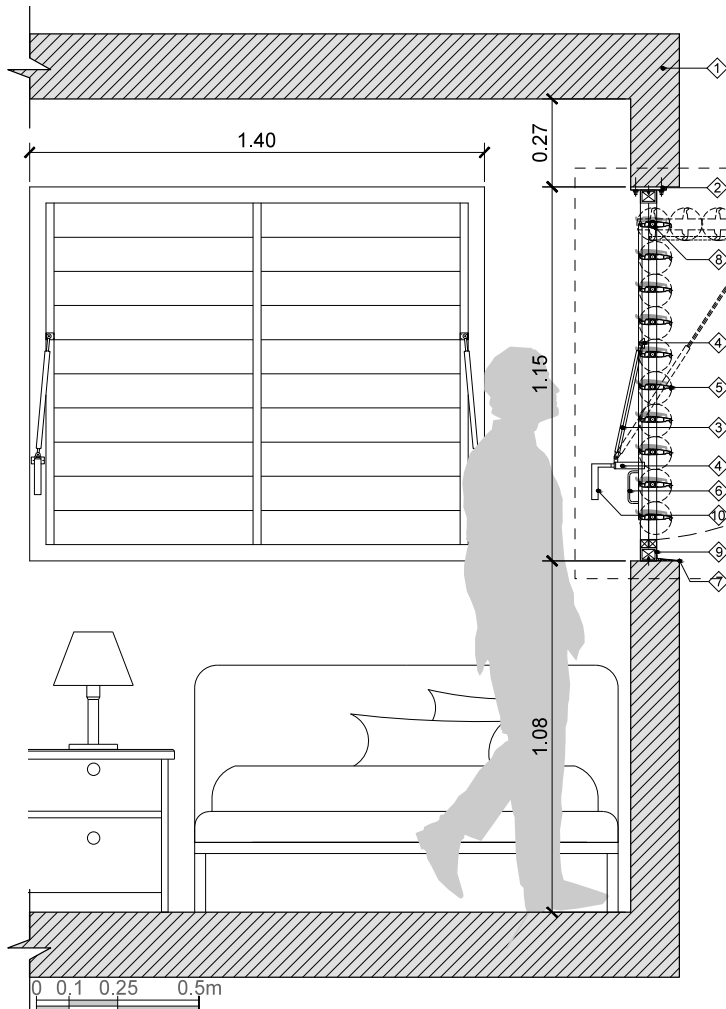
Sección propuesta, caso 1, protección dormitorio.
